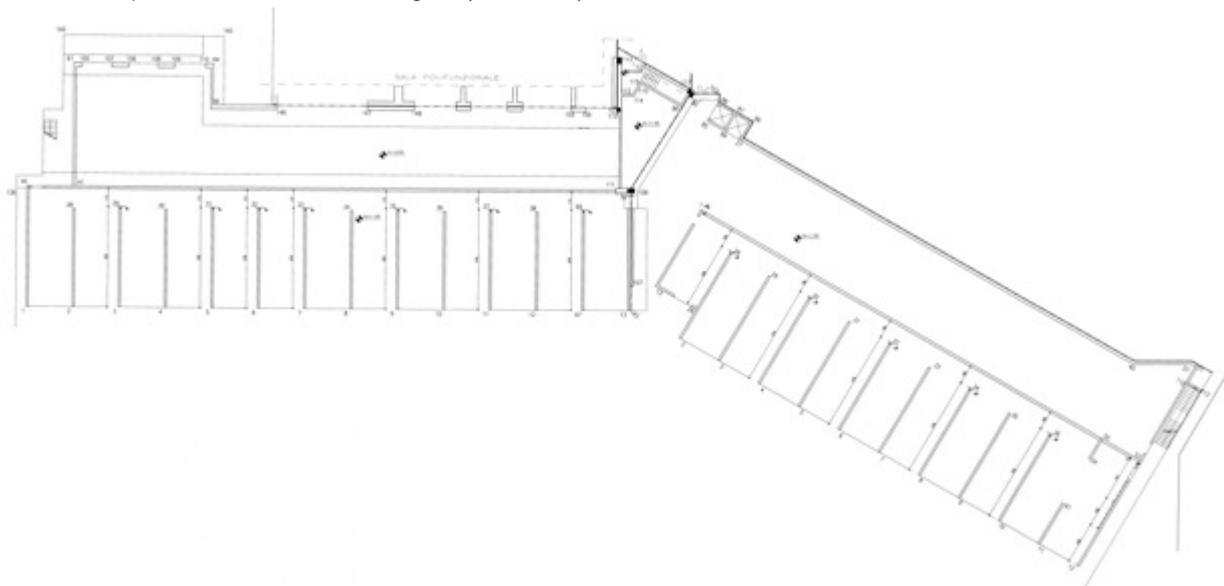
Carpenteria primo solaio (Progetto originale delle strutture oggetto di demolizione – BLOCCO B1 e B2).
